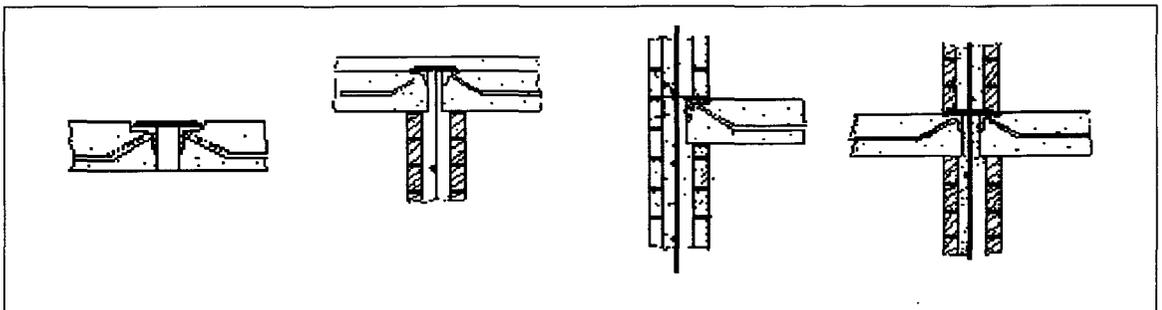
Pré-lajes ligadas por chapas soldadas (PARK, 1980, p. 498).
